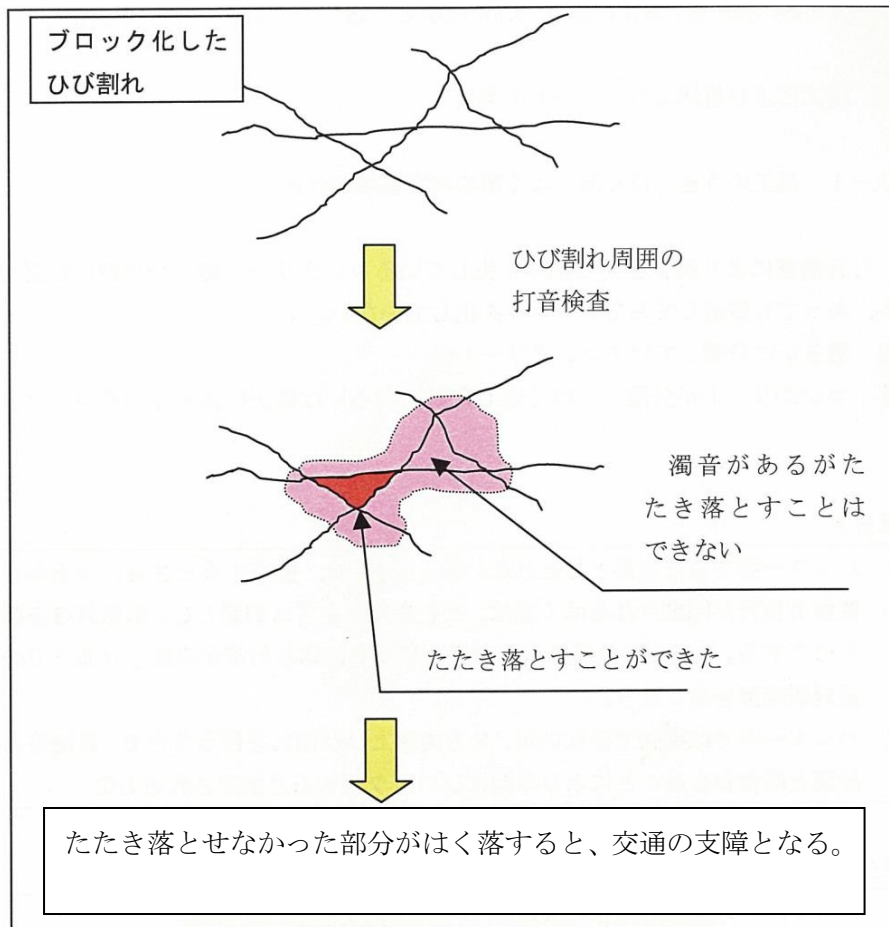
ブロック化したひび割れの例¹⁾
